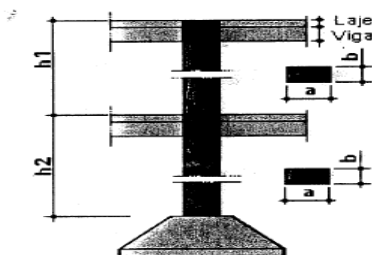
Medidas consideradas para o cálculo de betão dos Pilares.
